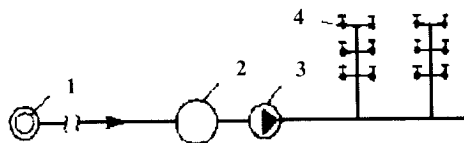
Схеми геотермального опалення і гарячого водопостачання
